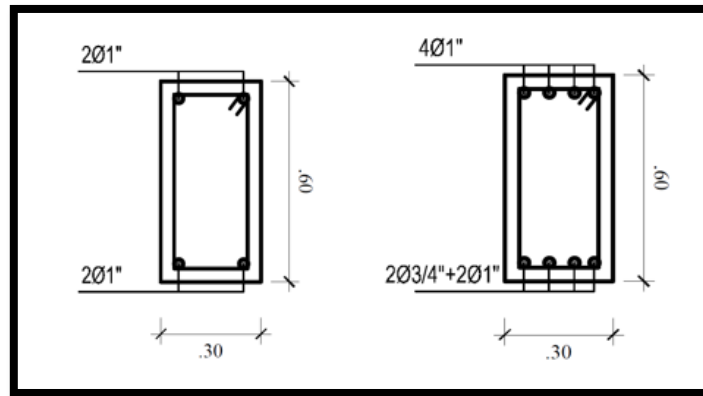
Distribución del refuerzo longitudinal a lo largo de la viga y en los apoyos de la viga de diseño.
